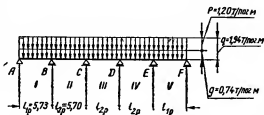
Расчетная схема второстепенной балки и расчетные нагрузки.
